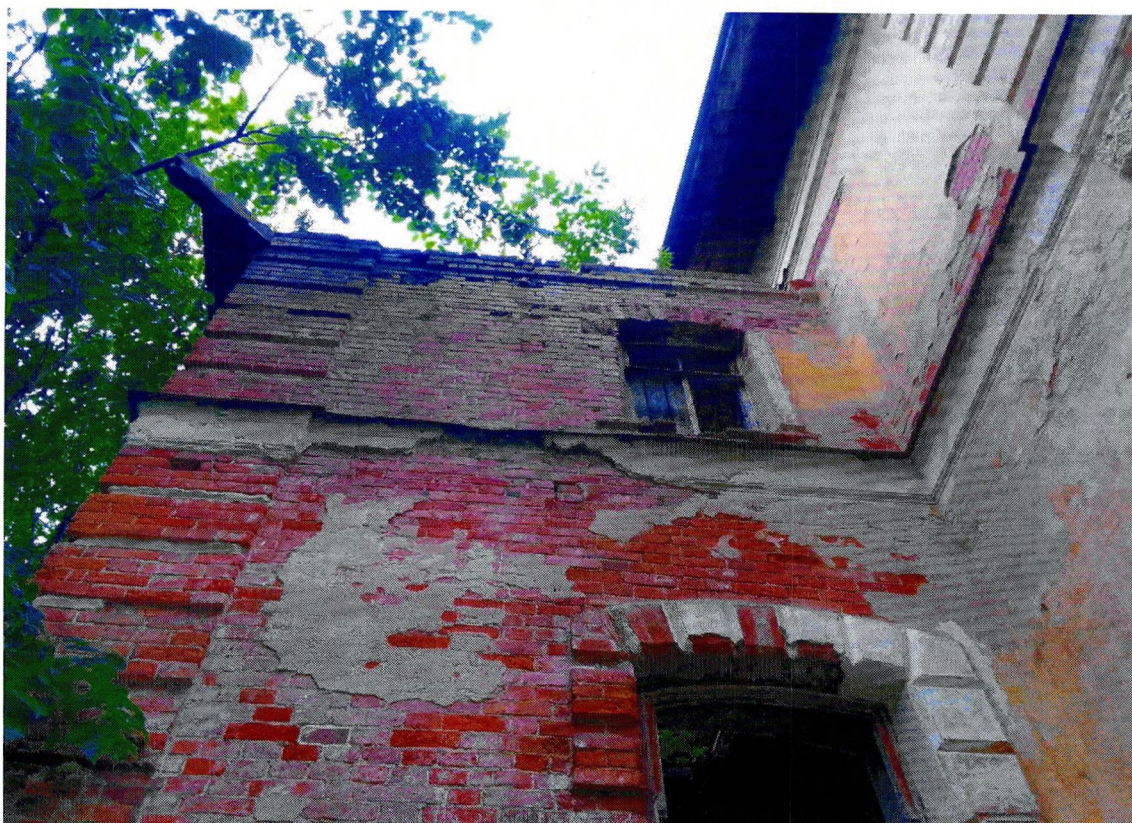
«Главный дом». Фрагмент северного фасада. Утраты штукатурного слоя, разрушение кирпичной кладки в уровне кровли, механические повреждения кладки.
